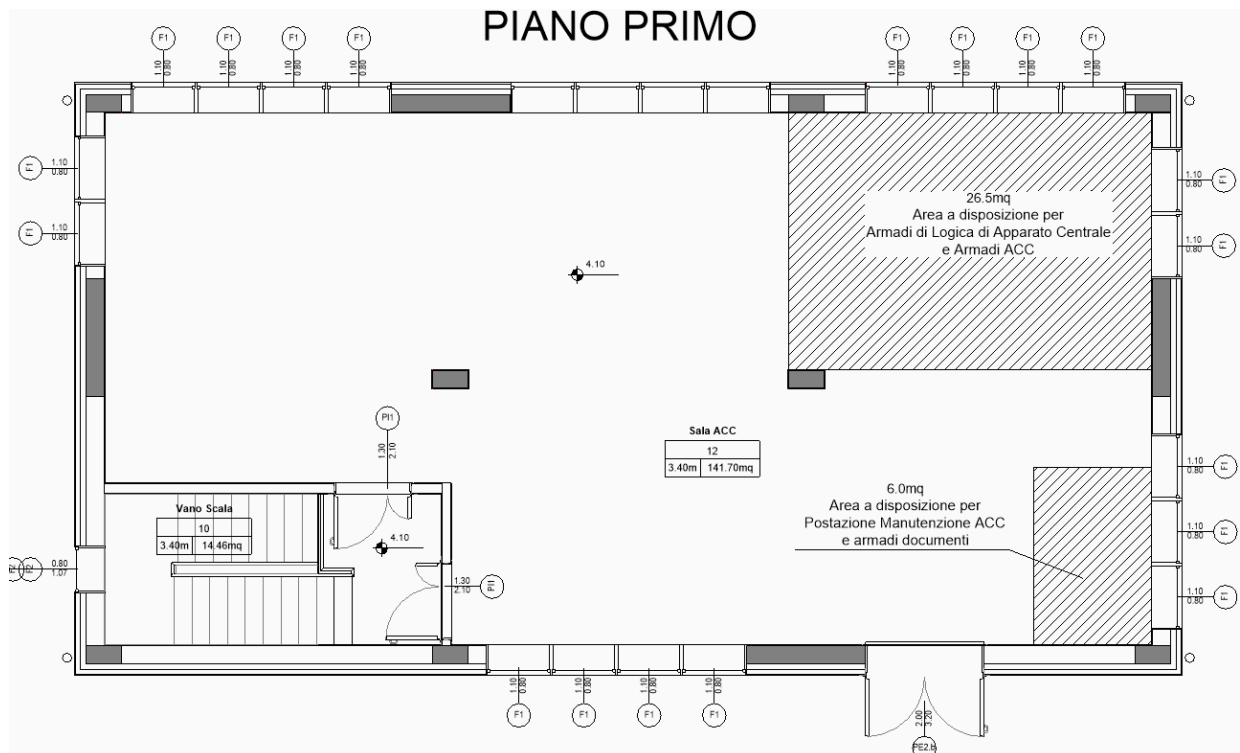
Layout GA2 ACC Bergamo (Sala ACC)
